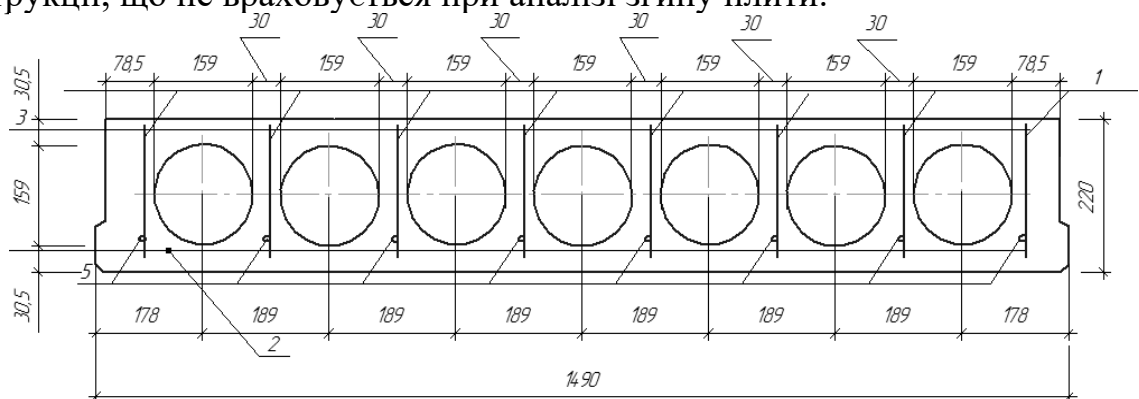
Поперечний переріз багатопустотної плити перекриття
